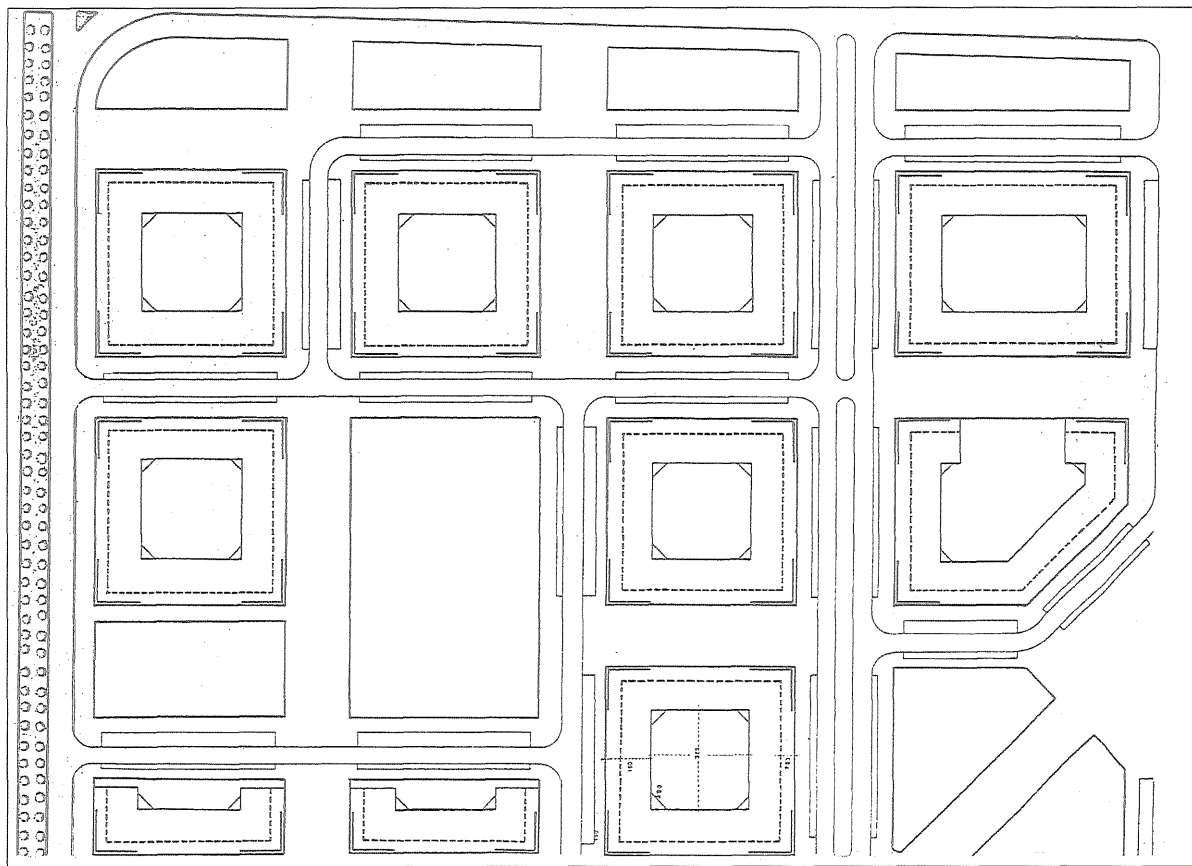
Plan Parcial del Sector n.º 2 de Lakua, 1985 (fragmento). Condiciones de ordenación de la edificación para la alternativa de redacción de Estudios de Detalle para manzanas completas de uso residencial: se ilustran gráficamente en este plano parte de las condiciones que describen las Ordenanzas; no se prescribe la edificación en manzana cerrada, simplemente se determinan los tramos de obligada coincidencia entre las alineaciones y las líneas de fachada, los retranqueos máximos de la fachada exterior y la línea obligada de fachada al espacio libre exterior.
